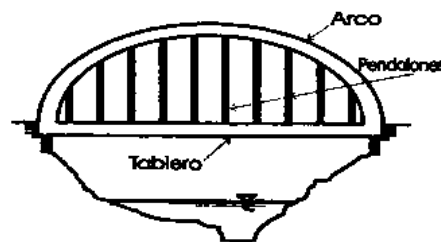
Puente en arco con tablero inferior. (CuevadelCivil, 2013)
